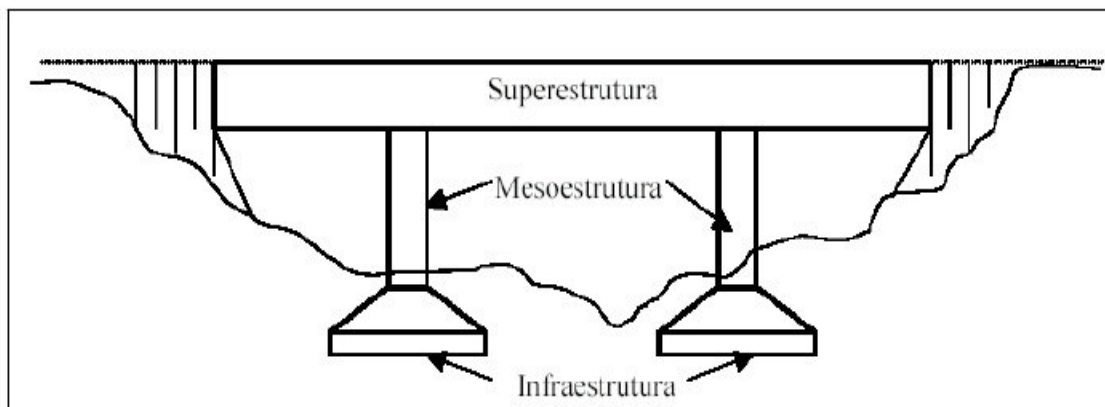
Divisão estrutural de uma ponte (Gomes, 2006)
